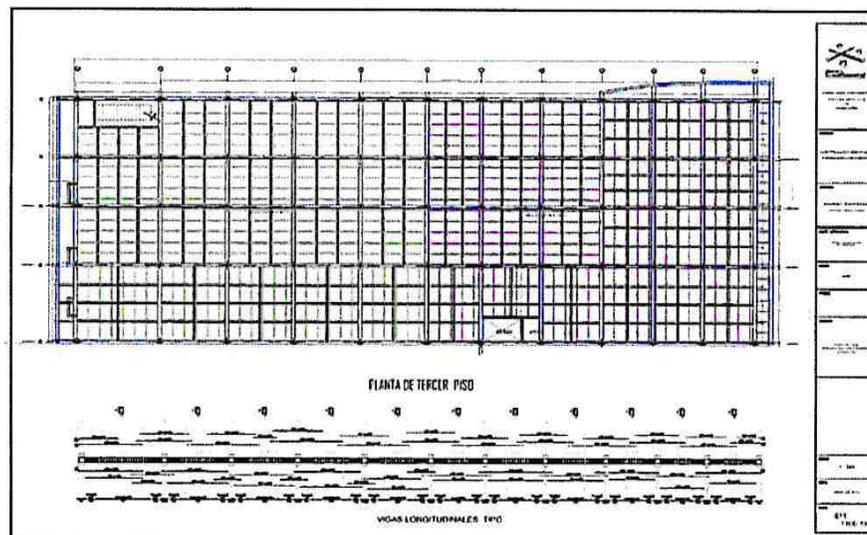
Vista- Planos Estructurales - Proyecto Tercer Piso Tornillería Continental.
